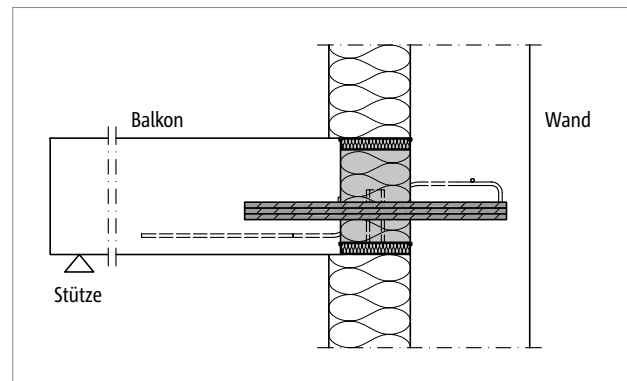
Schöck Isokorb® XT Typ Q, H-VV-NN: Anschluss an einer Stahlbetonwand mit Außendämmung
